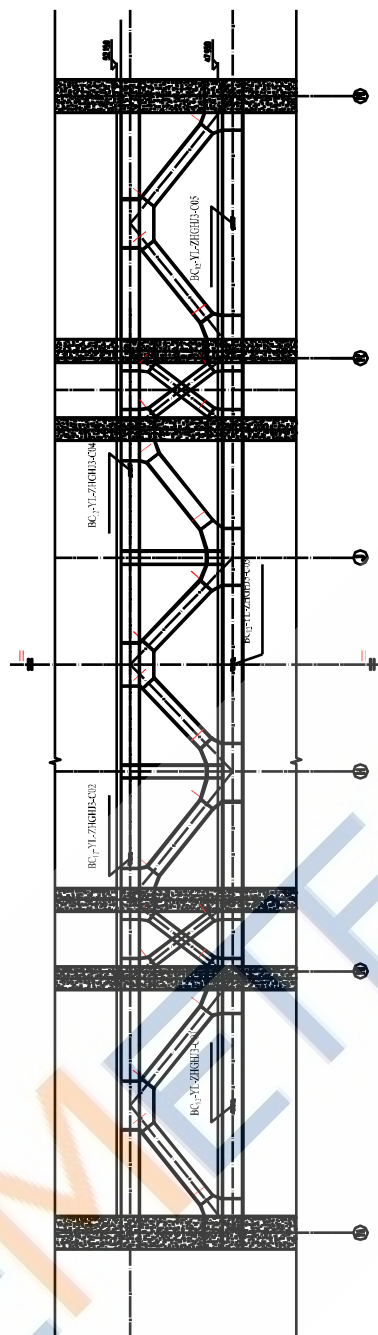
监测单元 BC₃ 钢桁架（转换桁架 ZHGHJ1）应力应变测点布置示意图
